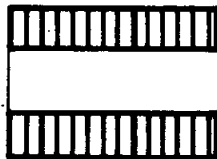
Vigas y pilares de sección transversal constante.
